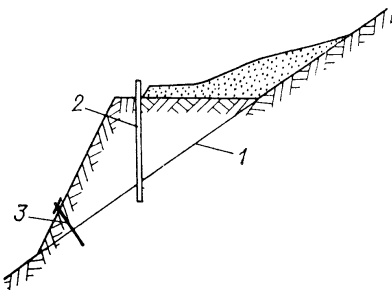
Берма відкосу, укріплення штангою та залізобетонним зв'язком: 1 – слабкий контакт, по якому можливе сповзання; 2 – залізобетонний зв'язок; 3 – штанга.
